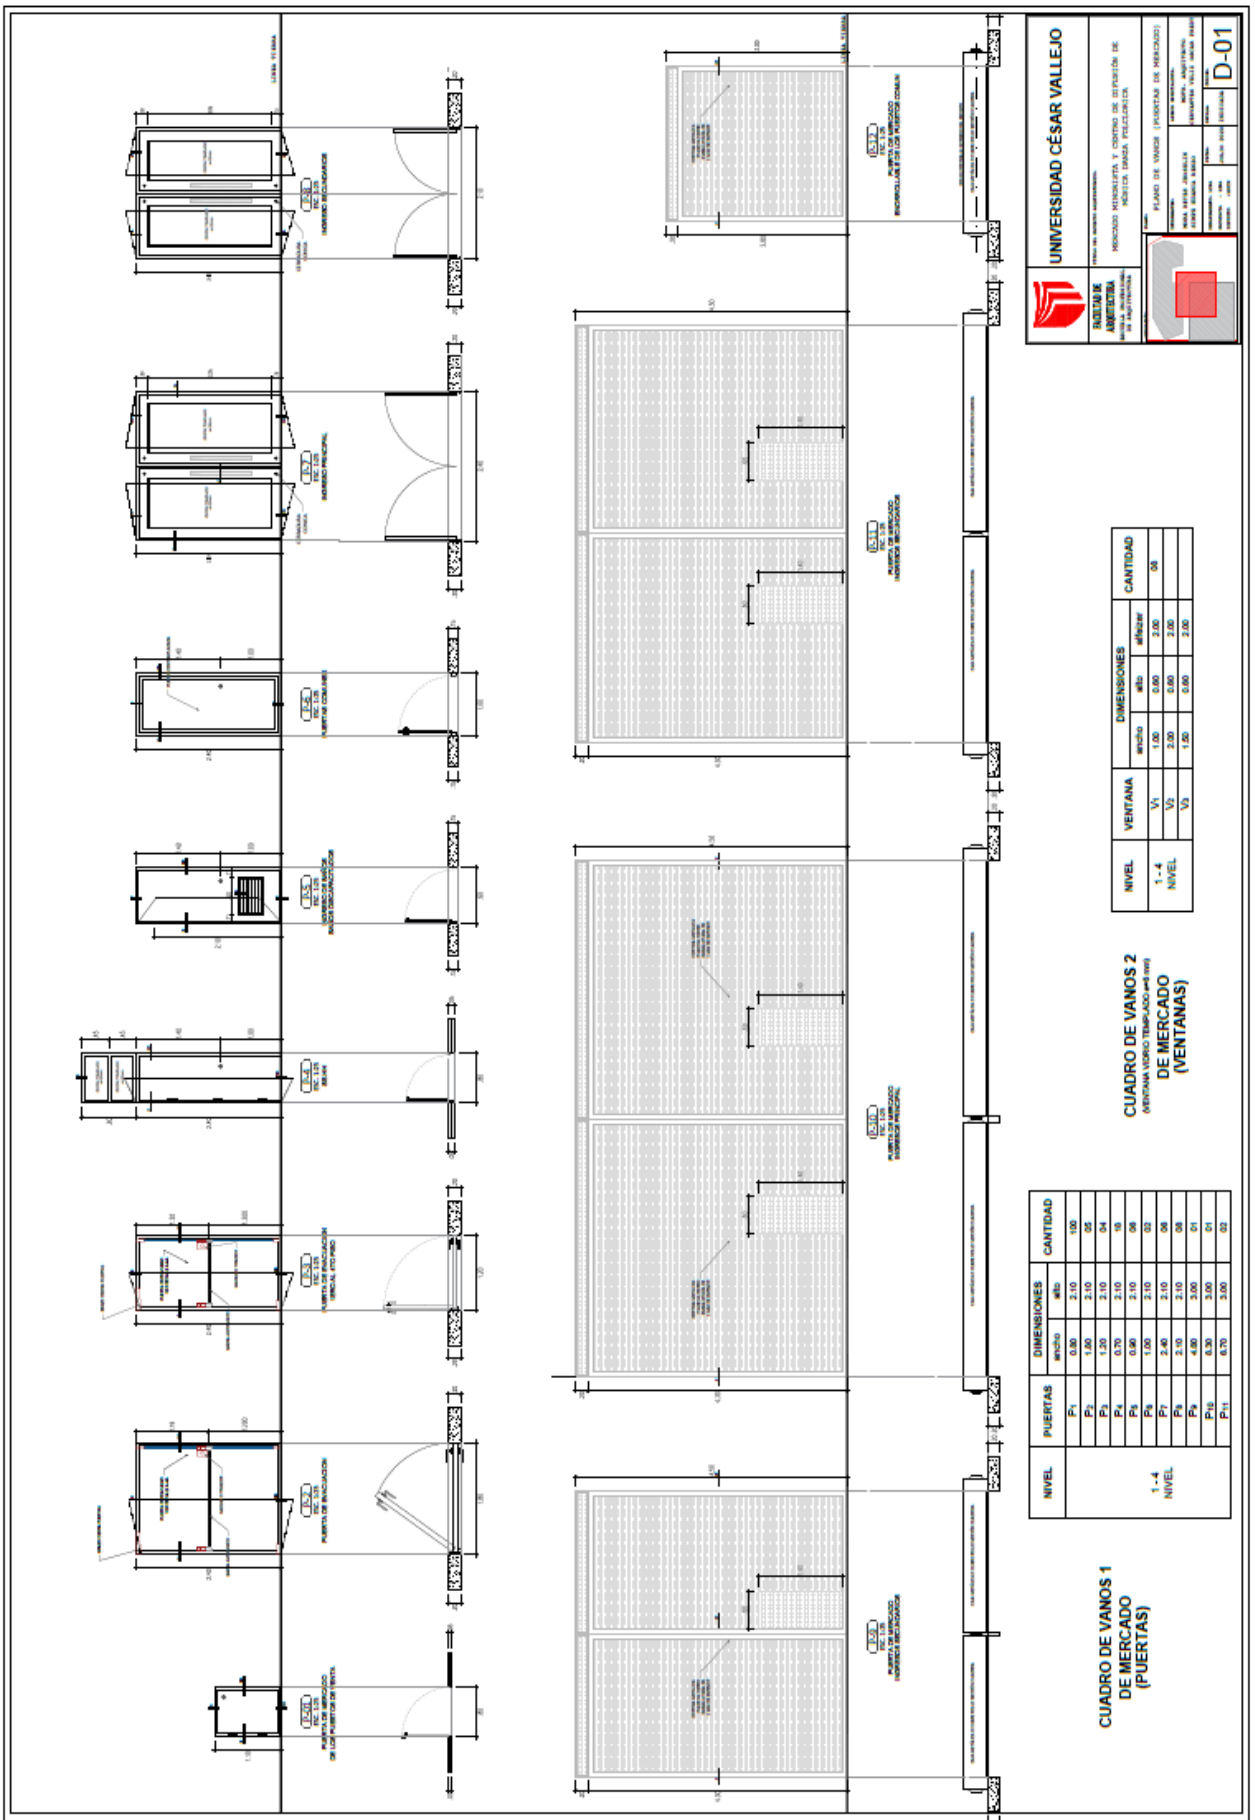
Plano de Vanos (Puertas) a Detalle - Proyecto Fuente: Elaboración propia
